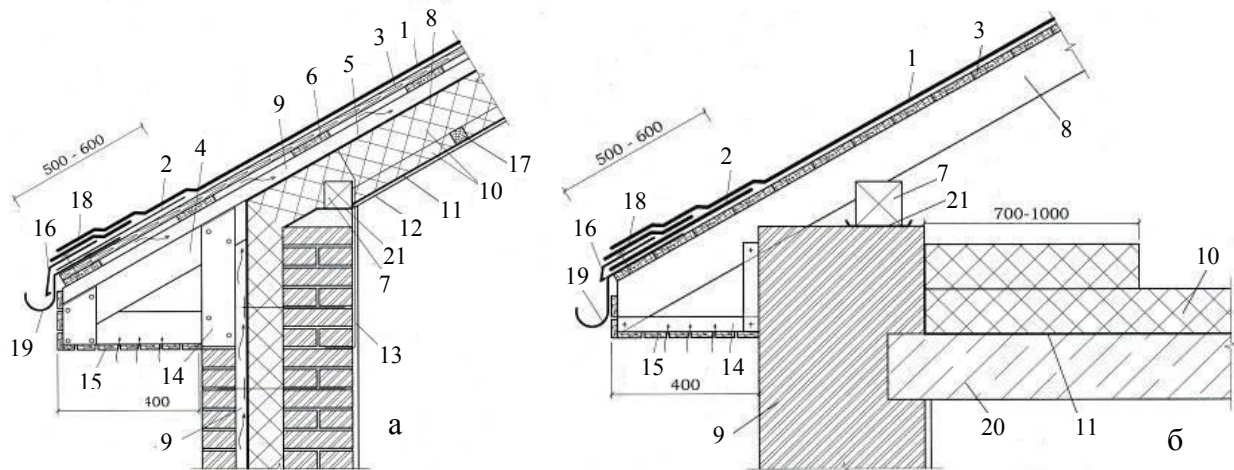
Схема карнизного вузла даху із гнучкої черепиці: а – мансардний поверх; б – холодне горище; 1 – гнучка черепиця; 2 – підкладний шар; 3 – суцільний настил; 4 – кобилка; 5 – повітрозахисна дифузійно-гідроізолювальна плівка; 6 – лати; 7 – мауерлат; 8 – кроква; 9 – вентиляційний проміжок; 10 – теплоізоляція; 11 – пароізоляція; 12 – гіпсокартон; 13 – анкер кріплення крокви та мауерлата; 14 – каркас карнизного звису; 15 – підшивка; 16 – крапельник; 17 – бруски; 18 – карнизна черепиця; 19 – ринва; 20 – плита перекриття; 21 – гідроізоляція
